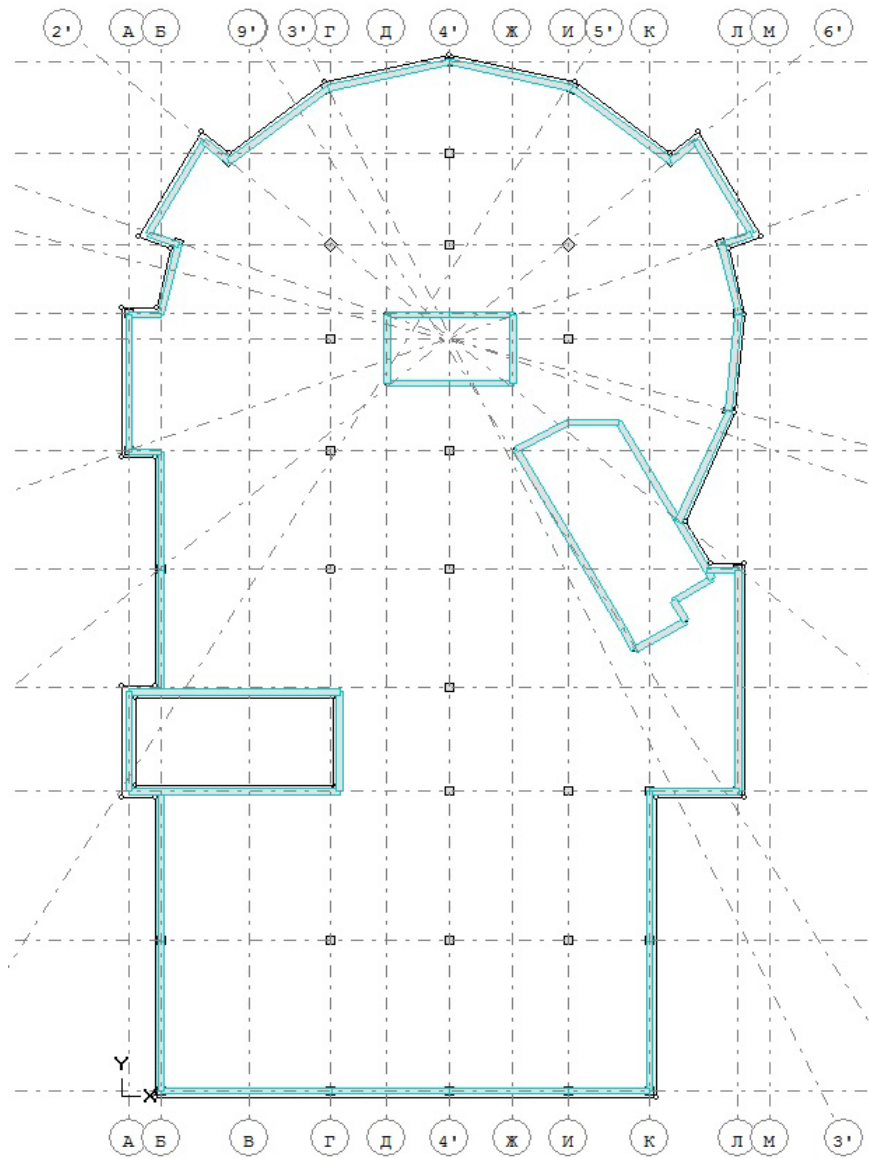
Опалубкове креслення плити перекриття першого поверху
